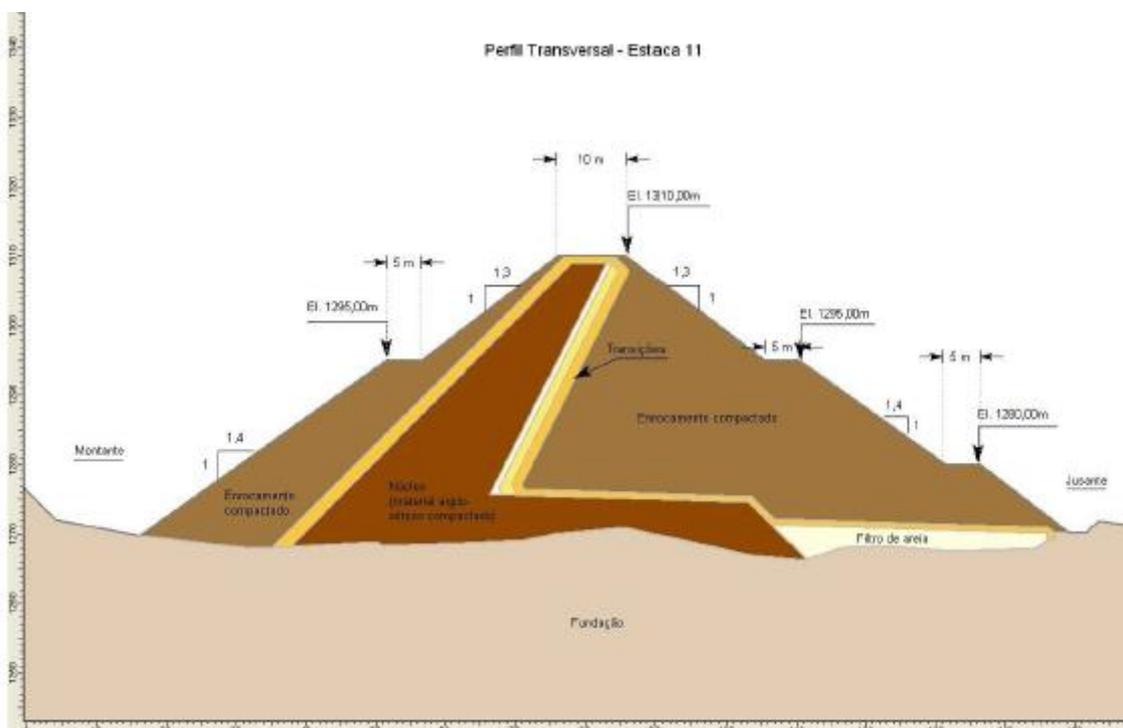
Seção transversal típica estaca 11 - Projeto Executivo
